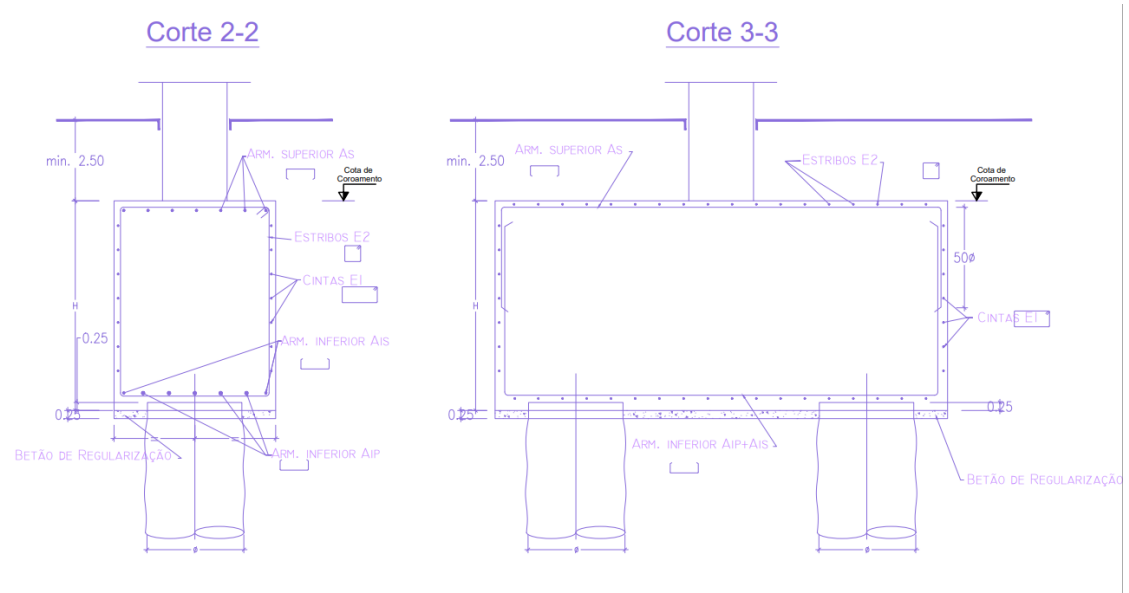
Corte 2-2 e 3-3- da planta do Maciço de duas estacas. Fonte: Projegui.
